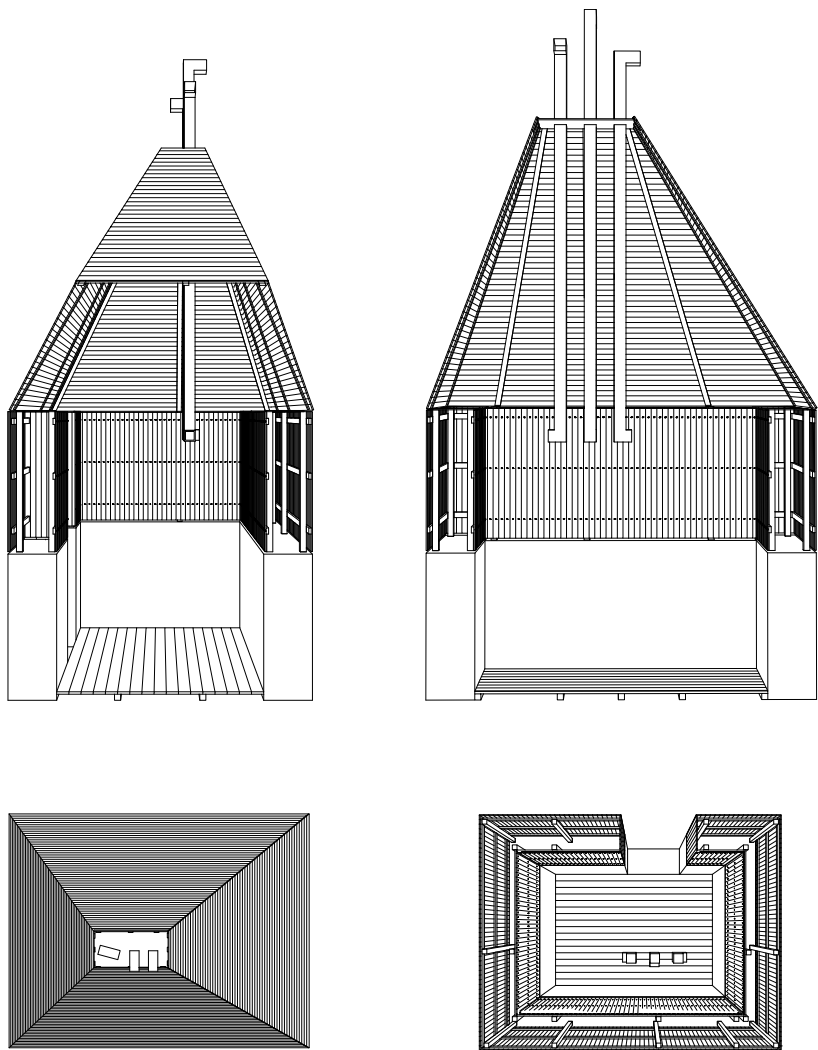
, Sezioni Prospettiche, pianta delle coperture, prospettiva acci-
